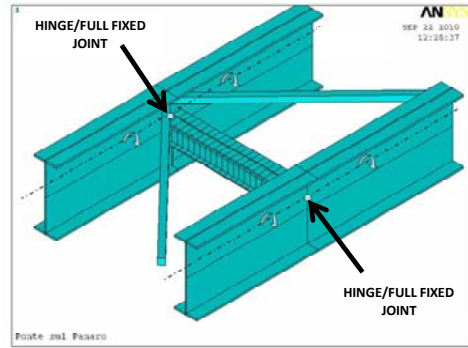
Ponte sul Panaro: collegamento trasverso locale / trave longitudinale secondaria mediante legami a incastro / cerniera
